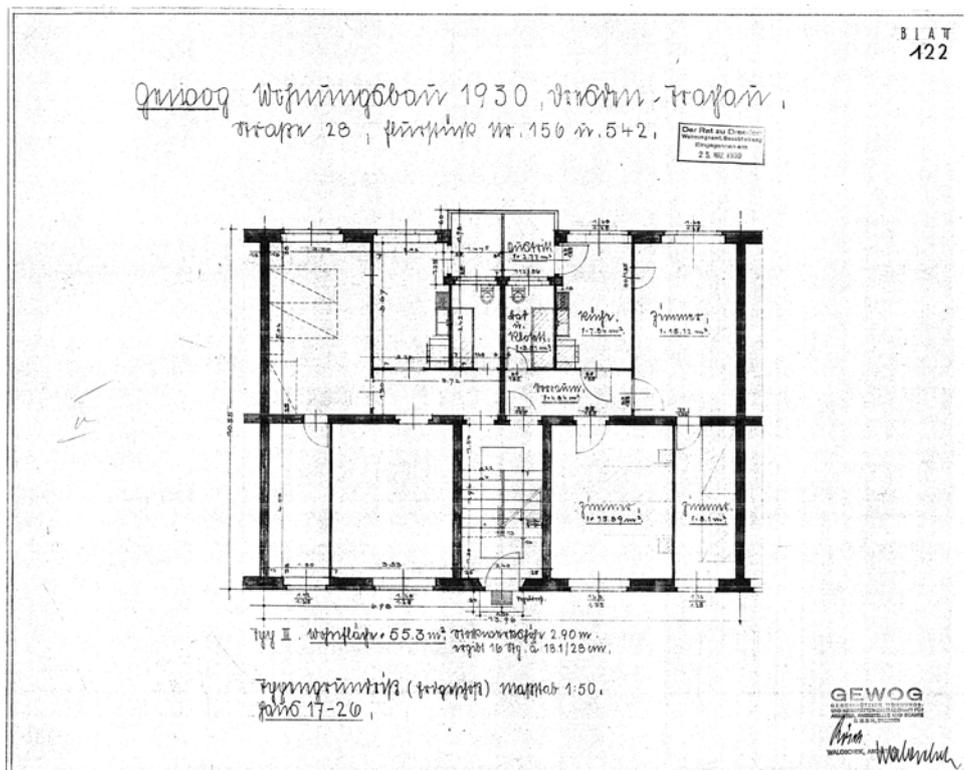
Hans Waloschek Typengrundriss als Zweispännerlösung für den Wohnungsbau 1930
